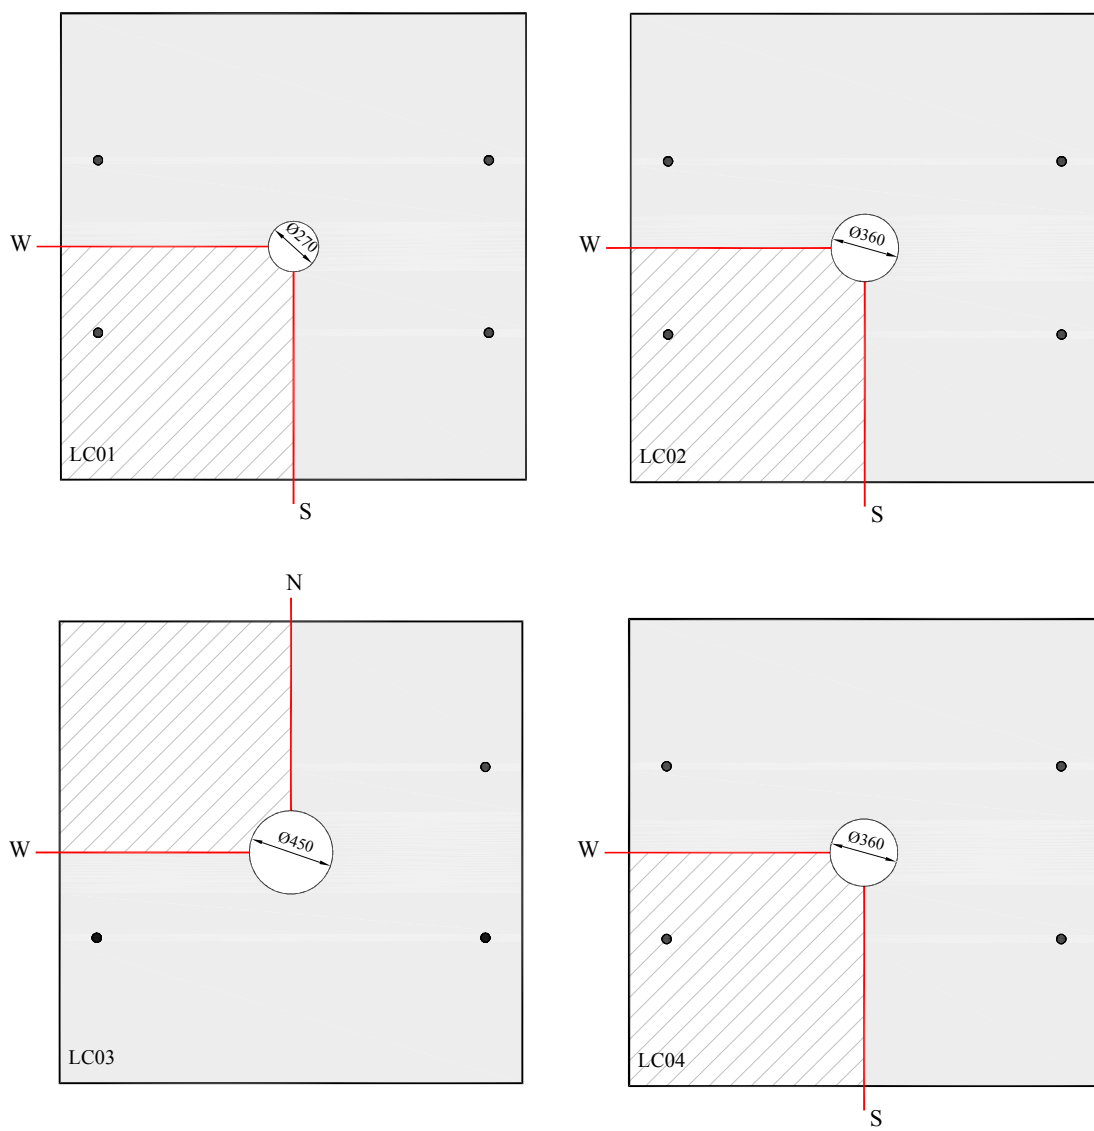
Plano de corte das lajes LC01 à LC04
